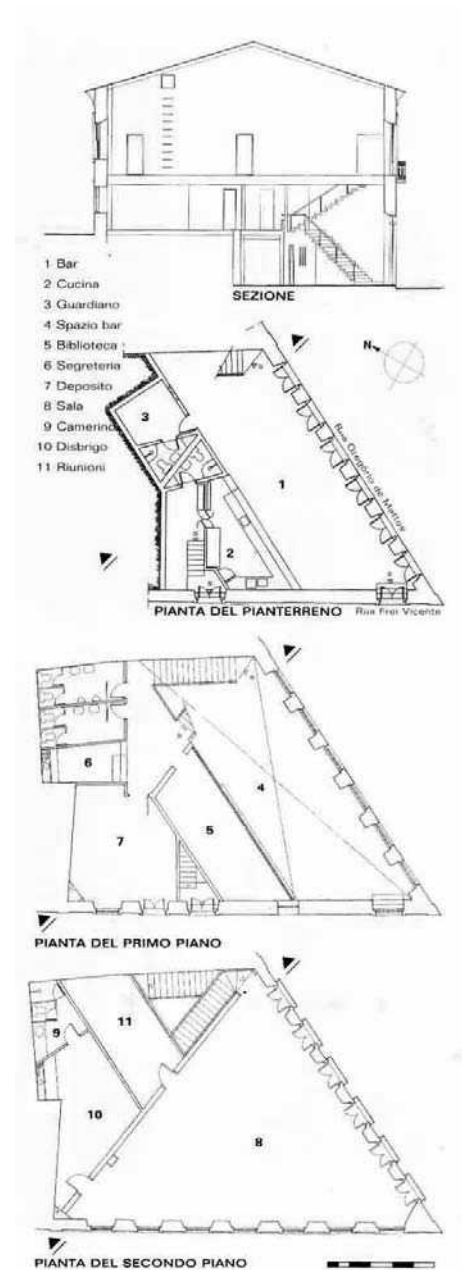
Plantas para intervenção na Casa do Olodum. Fonte: FERRAZ, 1996, p.291.
